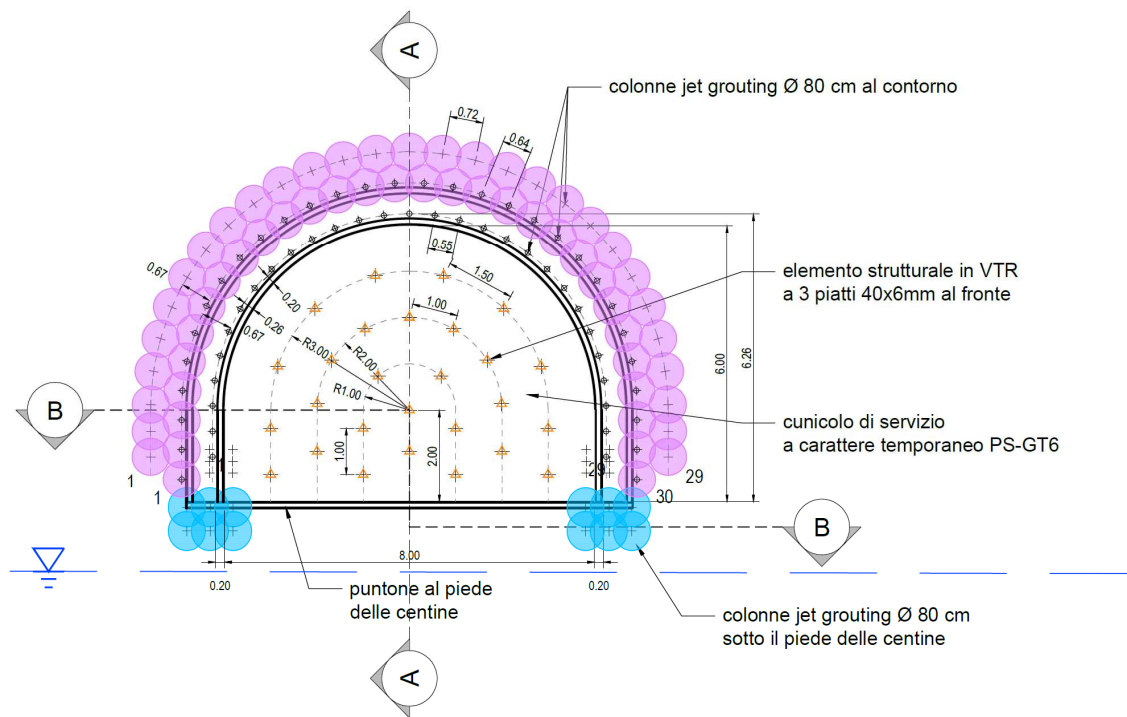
Trattamento jet grouting per il cunicolo PS-GT6: sezione trasversale.
